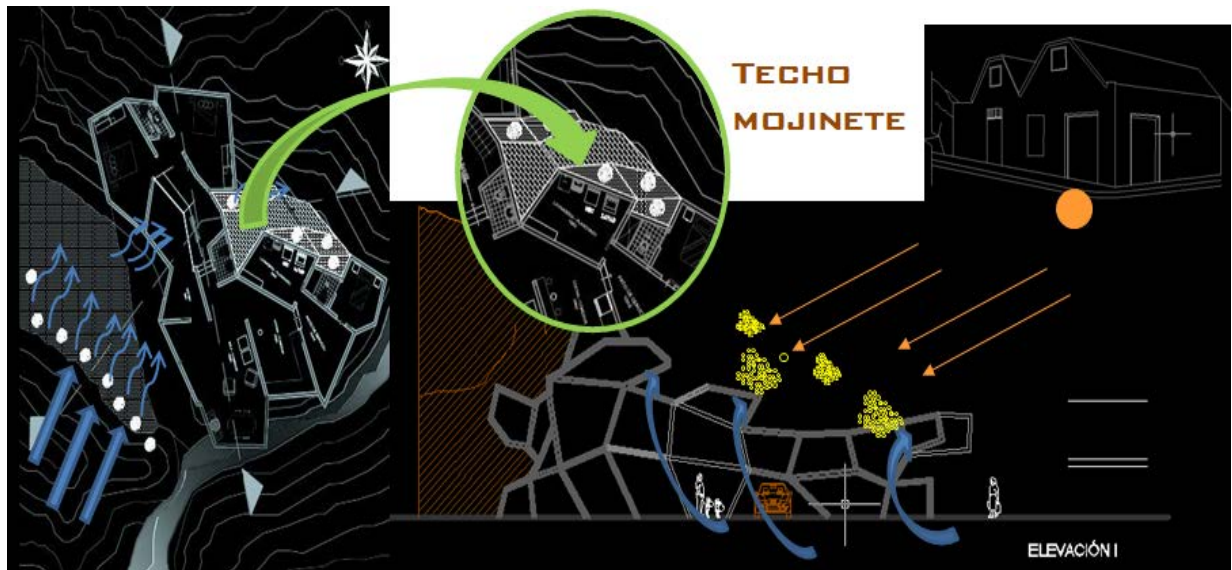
Planta del Prototipo (Fab Academy-Lima, 2011)
